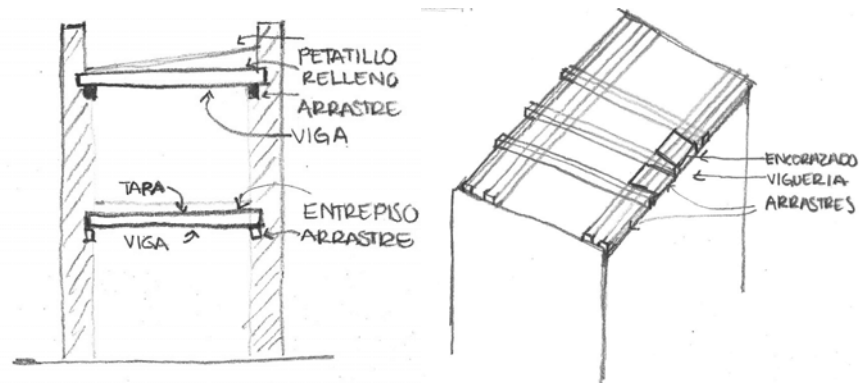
croquis constructivo de cubiertas y entrepisos. Elaboró: METR
